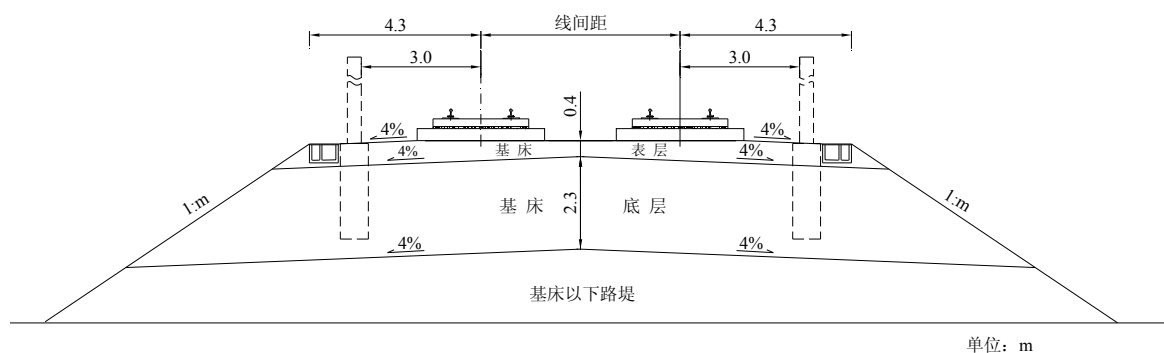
无砟轨道双线路堤标准横断面示意图
